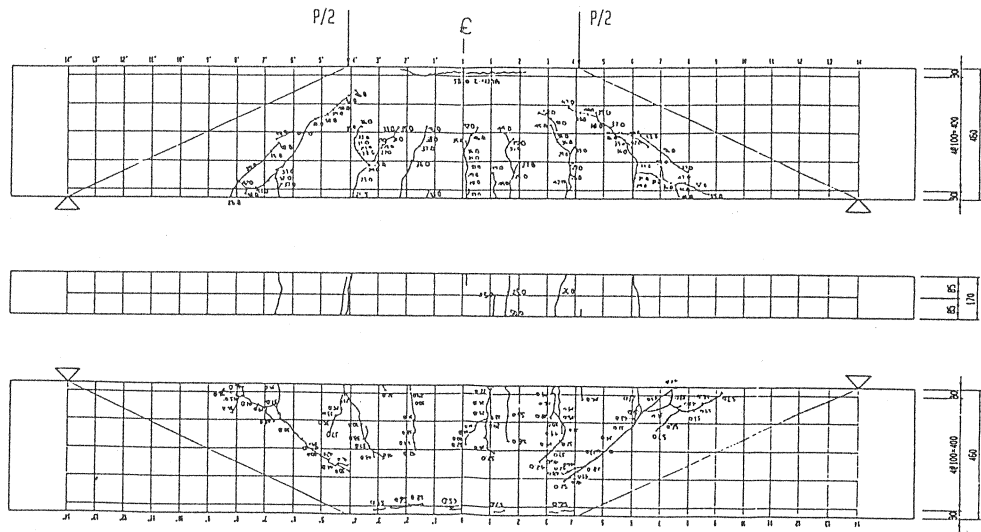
破壊試験後のひび割れ状況 (No10 試験体)
